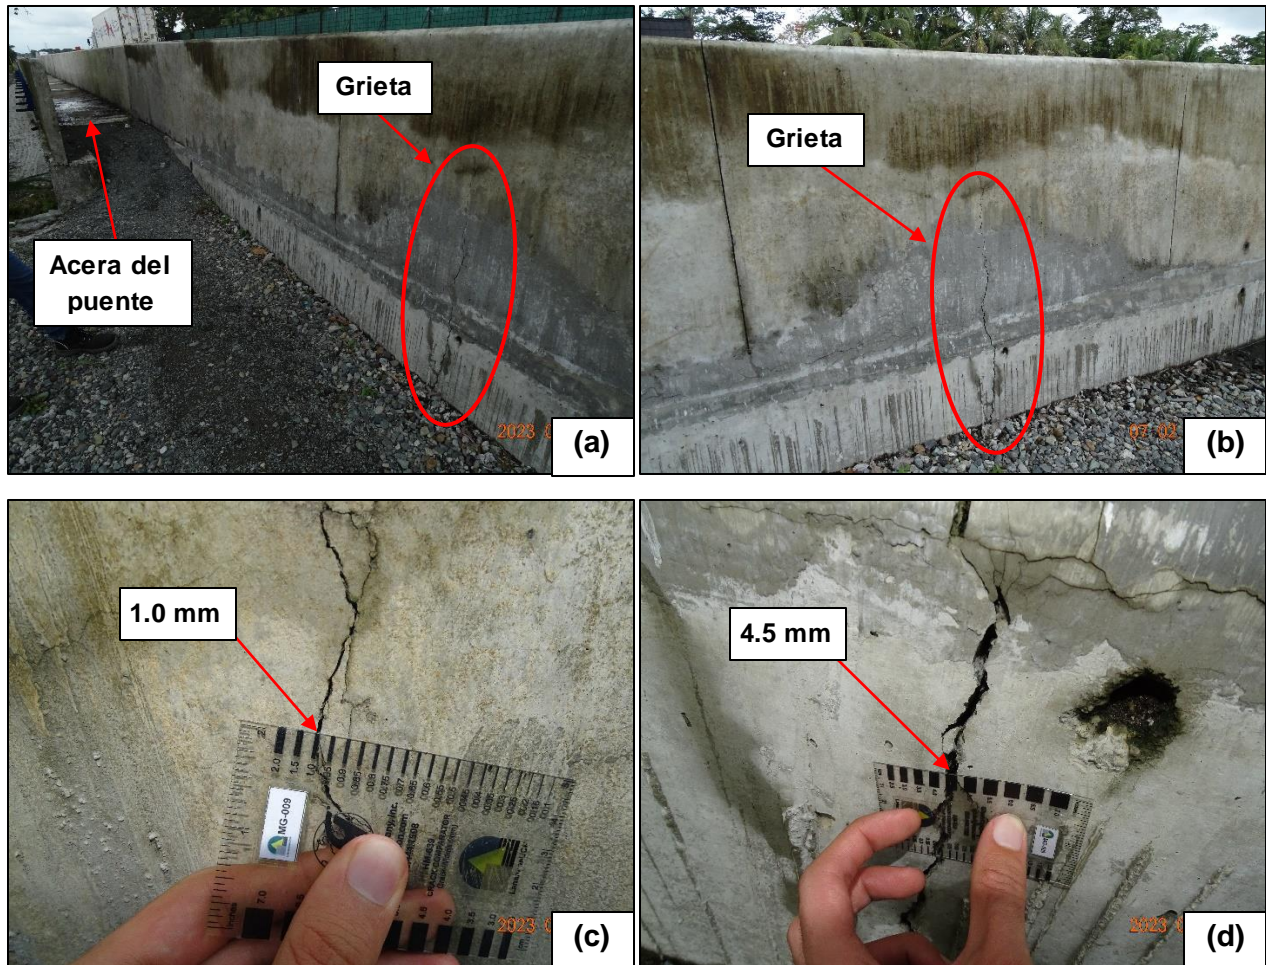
Grieta en la parte posterior de la barrera vehicular del Acceso 2 del puente nuevo sobre el río Toro. (a) Ubicación de la grieta. (b) Vista general de la barrera vehicular con la grieta. (c) Espesor de la grieta medido en la parte superior. (d) Espesor de la grieta medido cerca de la base.
